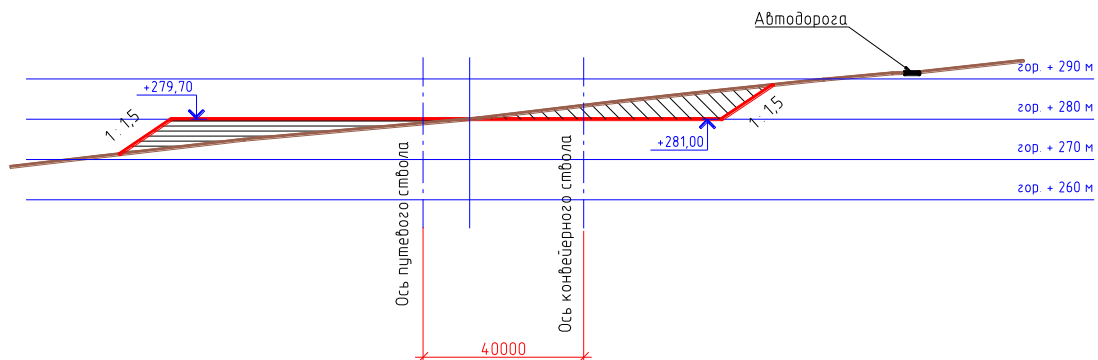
Поперечный разрез 1-1 площадки 2
